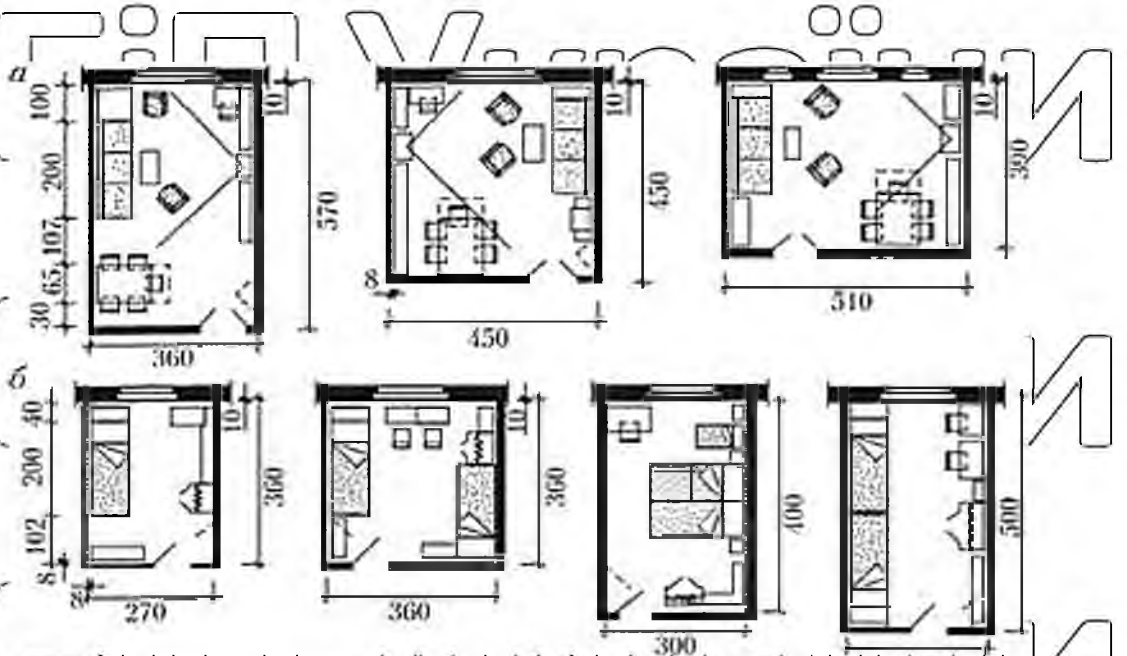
Модулі типових планувальних рішень житлових кімнат квартир:
